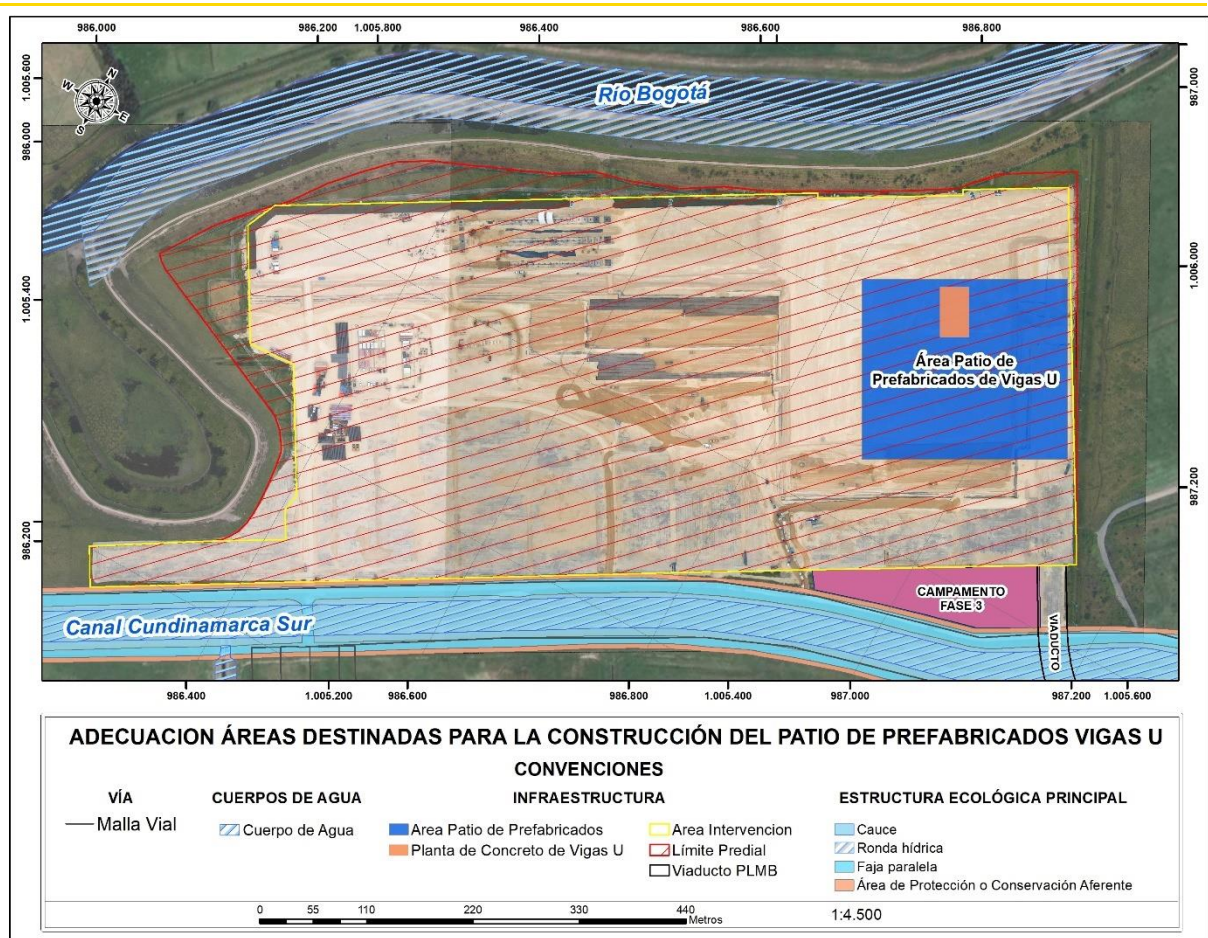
Área destinada para la adecuación para la construcción del patio de prefabricados de vigas U
